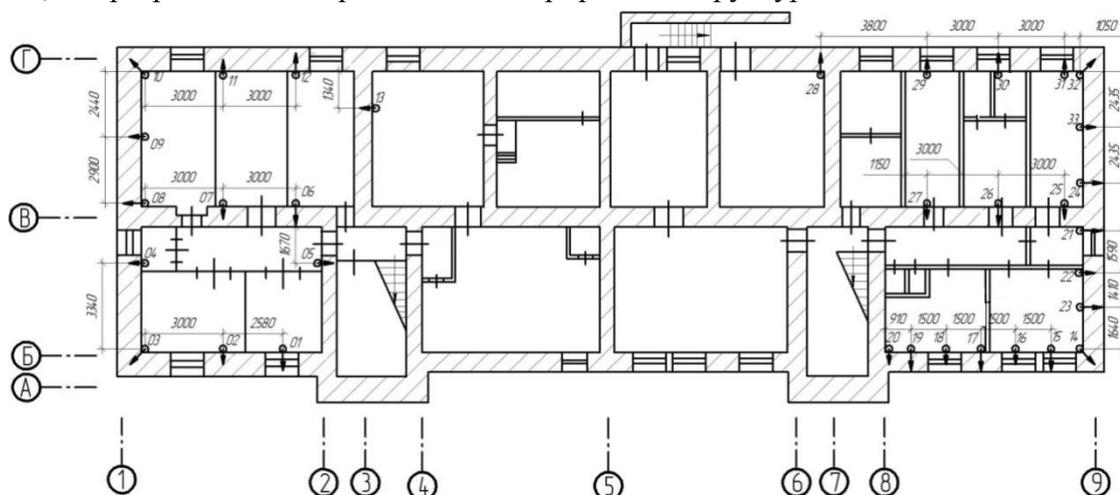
План скважин инъекционного закрепления грунта ГЦС
